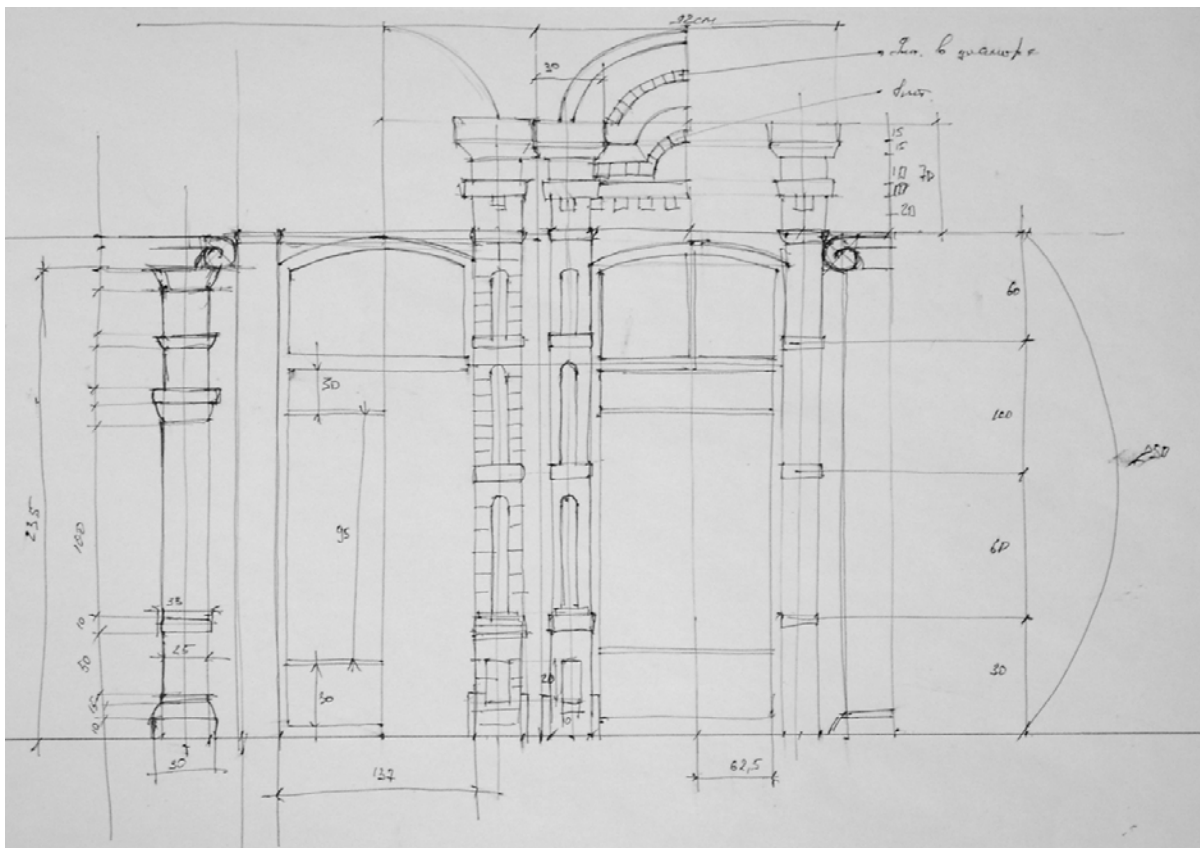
Пример выполнения кроки фрагмента фасада здания
